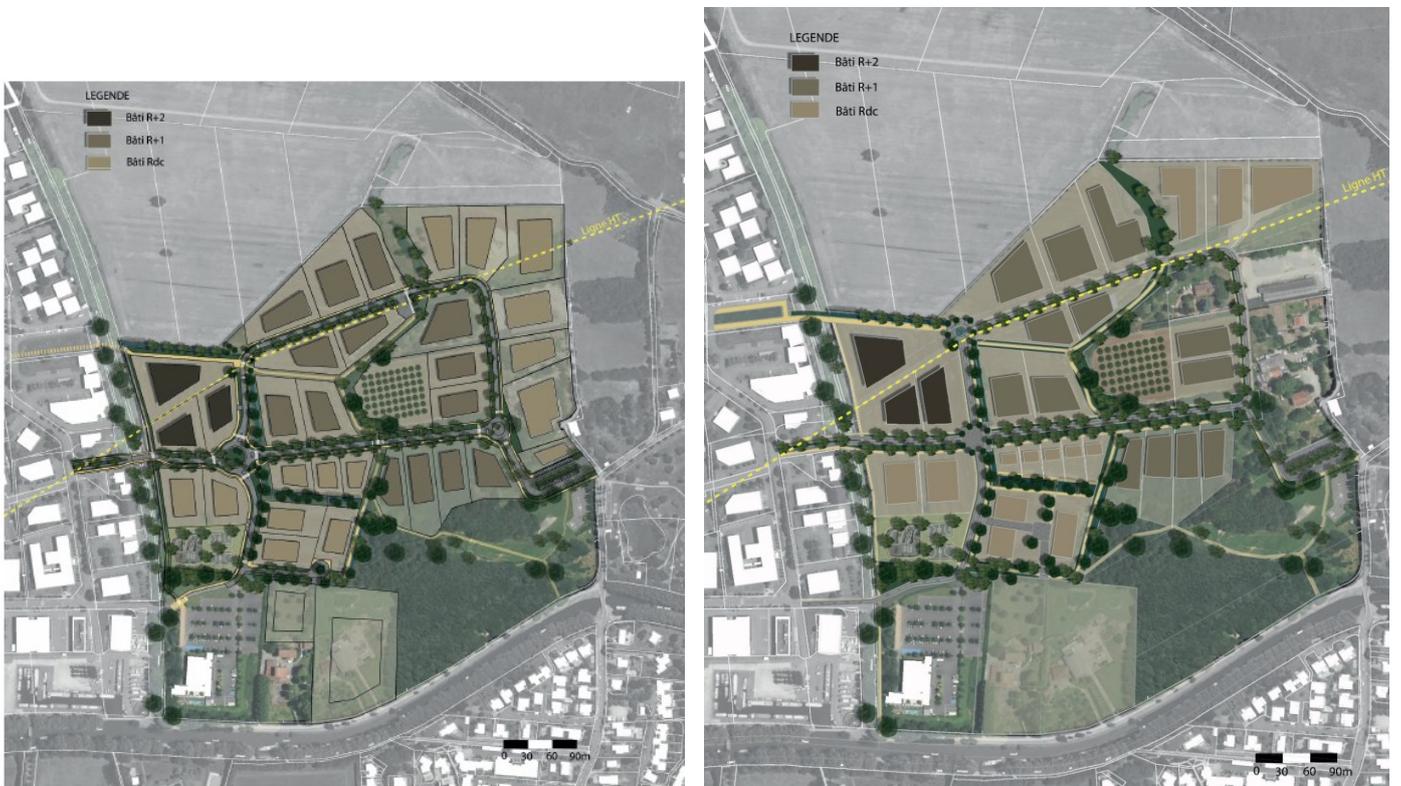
Comparaison du plan masse AVP avec le plan masse de l'étude urbaine.
